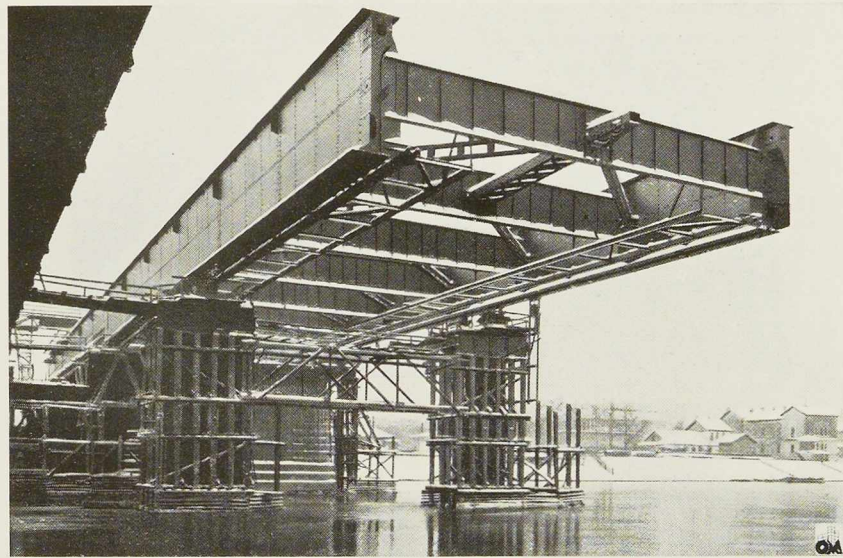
Montage en porte-à-faux des poutres de rigidité. On note les entretoises et les pièces de contreventement.
